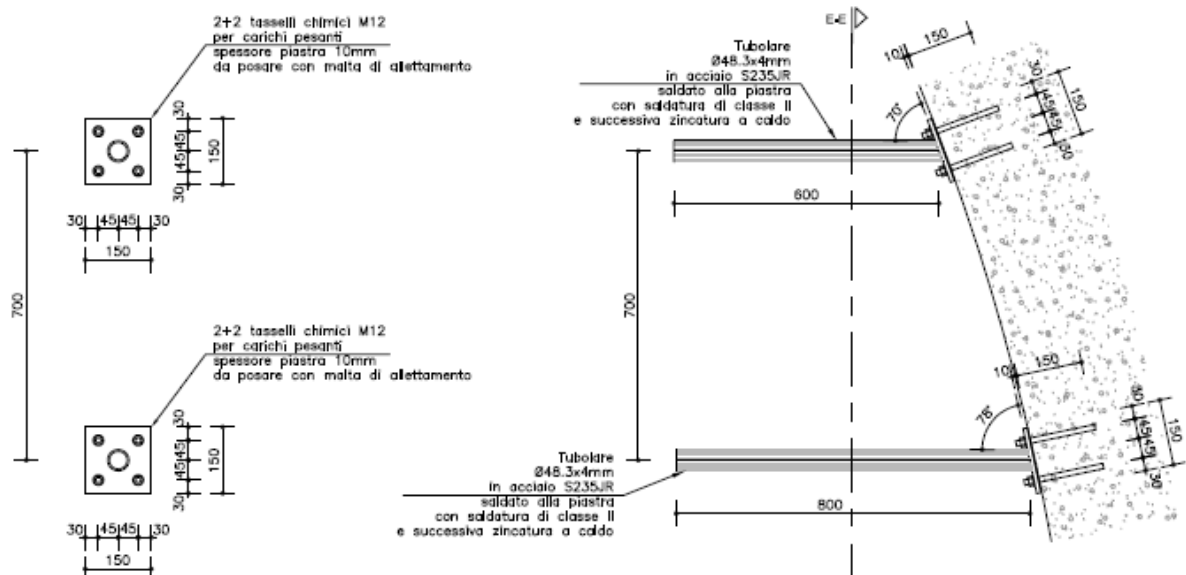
Cartello Rettangolare su piedritto galleria – Dettaglio ancoraggio
